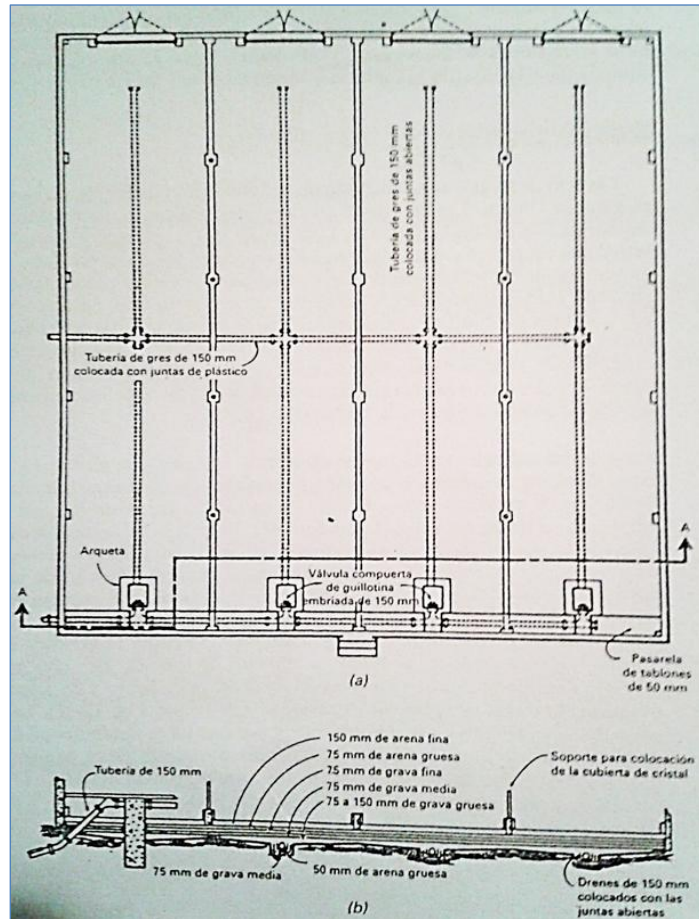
Planta y sección de una era de secado de fango típica: (a) planta y (b) sección A-A
